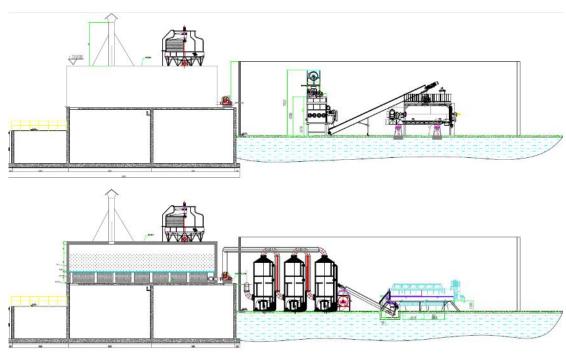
羽毛粉车间与污水处理设施相对位置立面图
